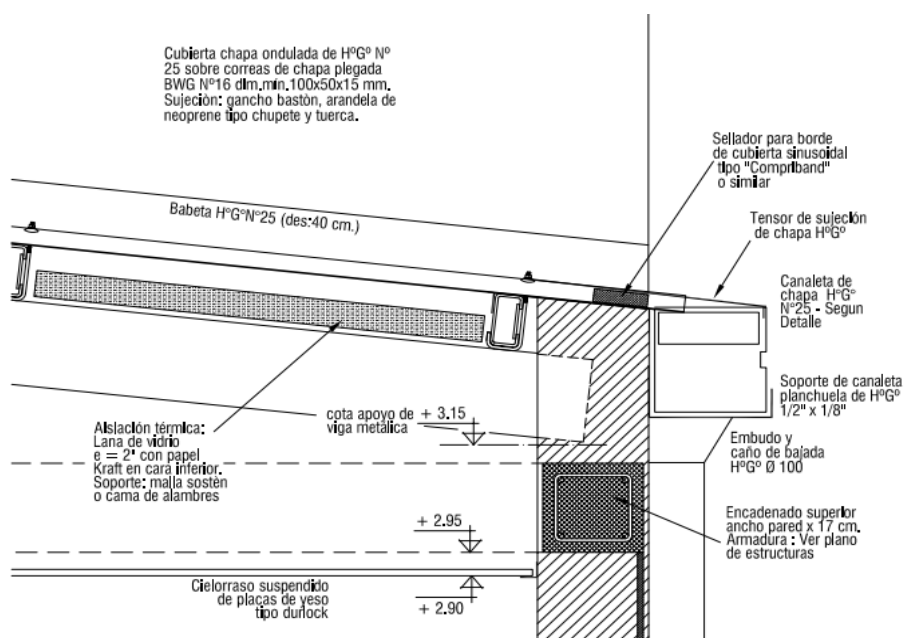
Detalle de encuentro de techo muro cielorraso. PT60.
